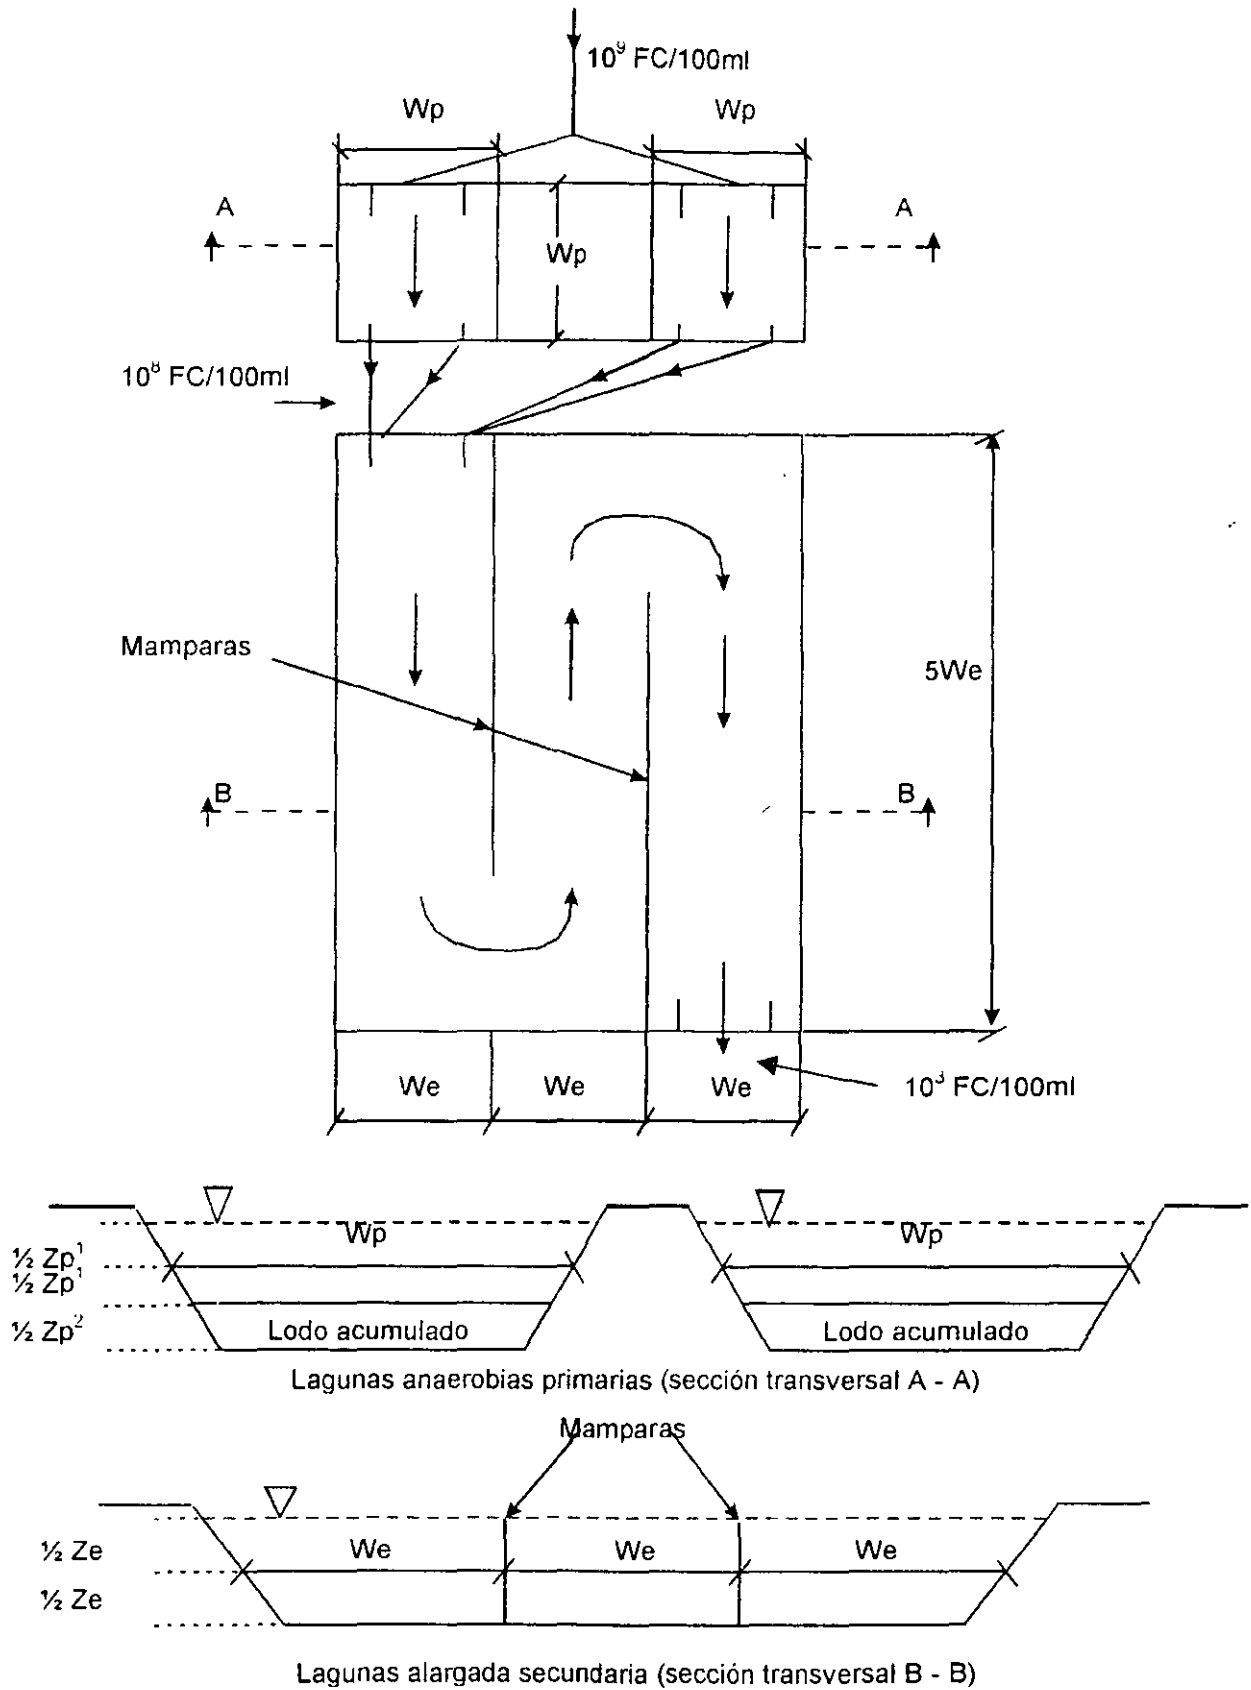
Esquema para el diseño de lagunas anaerobias primarias y lagunas alargadas secundarias en terrenos planos o ligeramente inclinados
